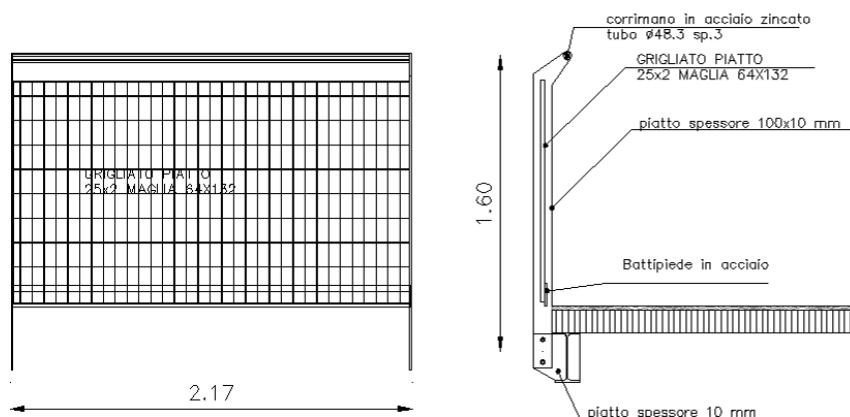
Parapetto di protezione della passerella carrabile di attraversamento
